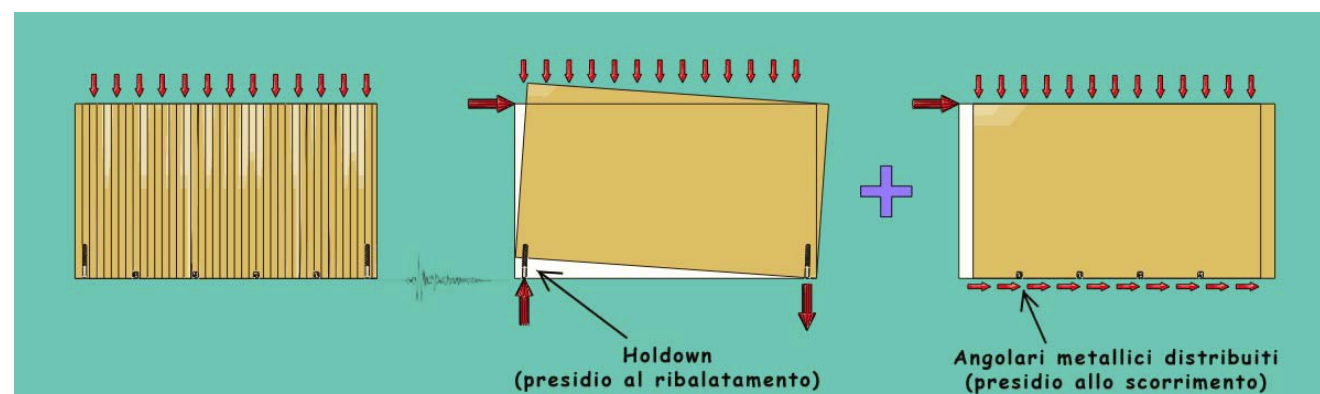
Effetti dell'azione sismica agente su una parete e diversa funzione degli elementi di collegamento.
